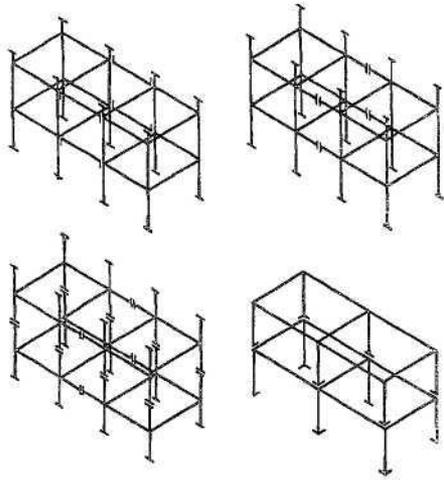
Членение каркаса на монтажные блоки и элементы
